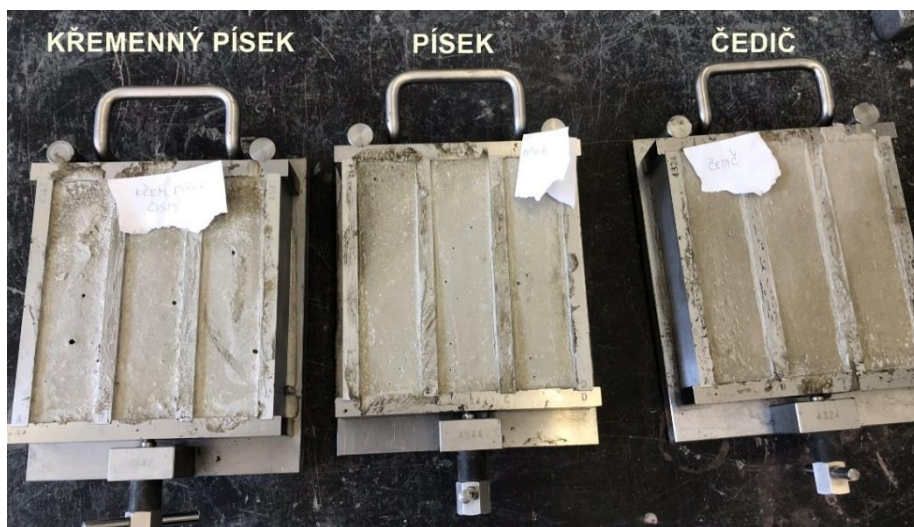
Čerstvá betonová směs s pigmentem (autor BP)
